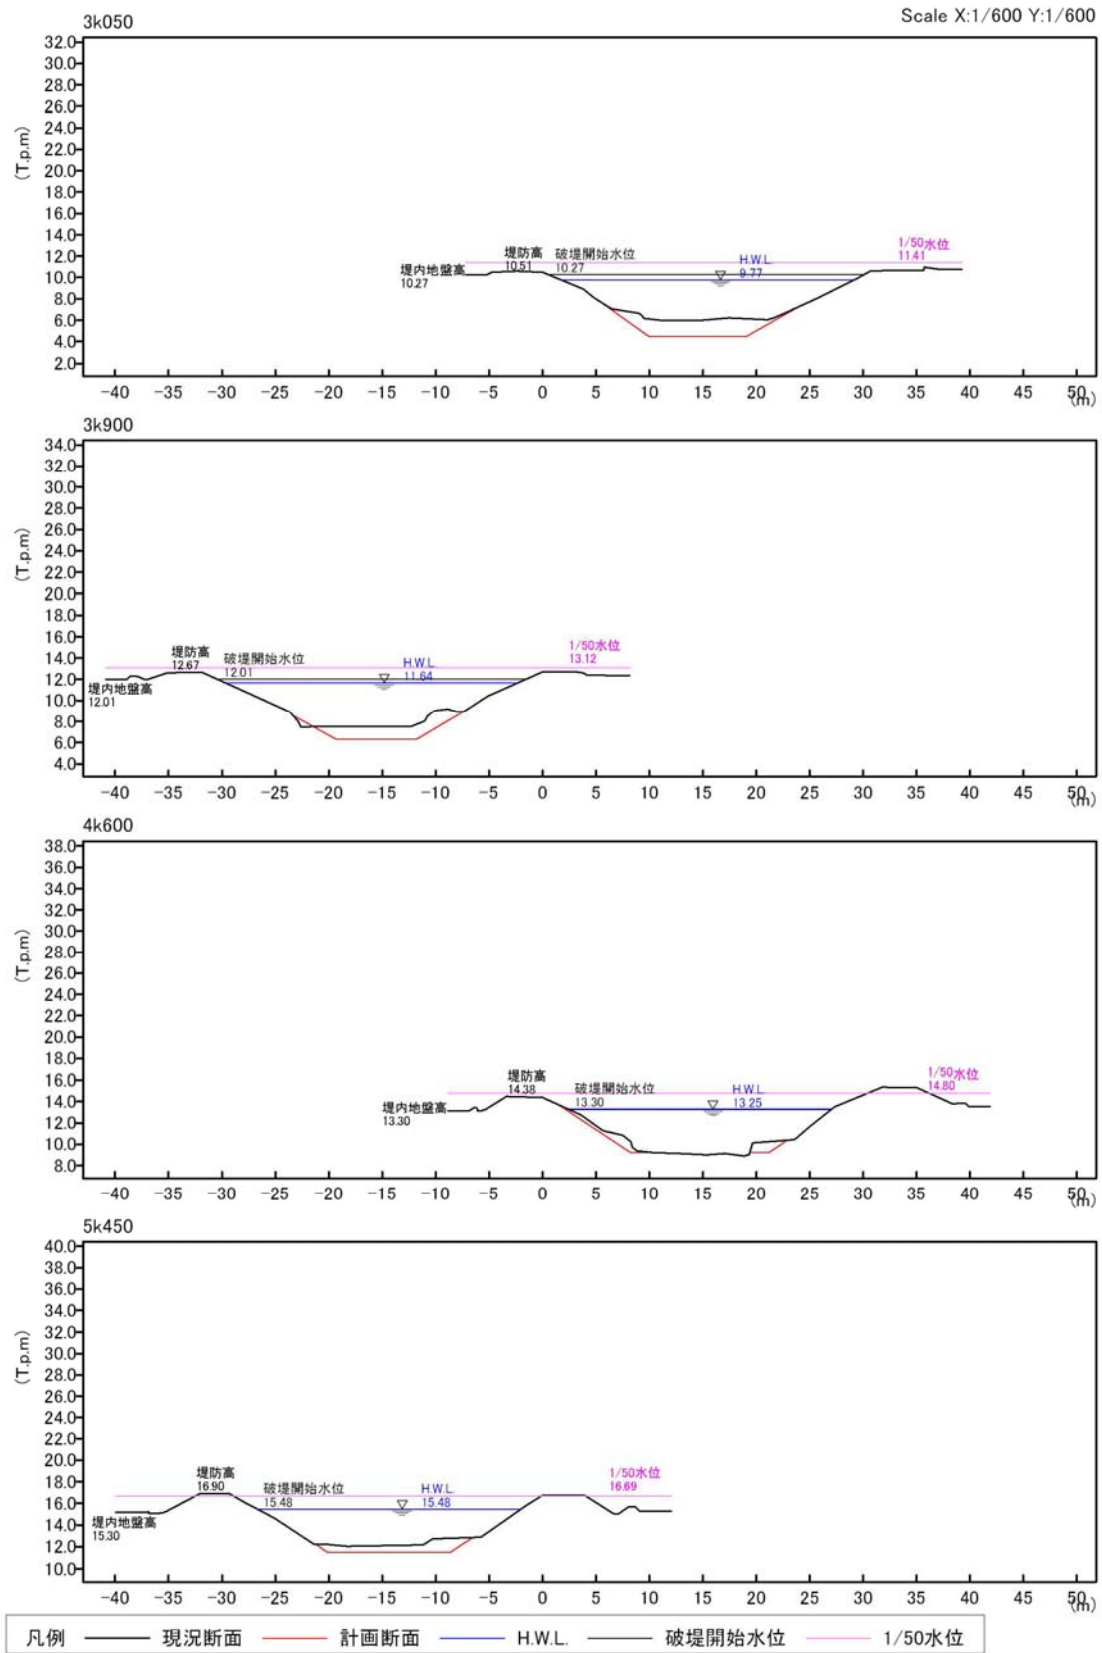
破堤箇所横断面図 都治川左岸 (2/3)
